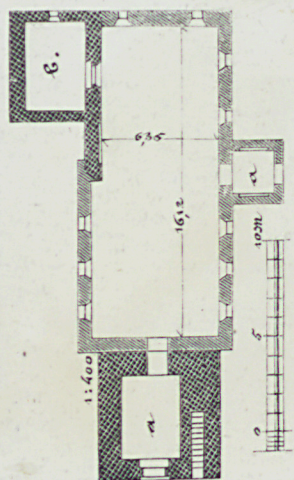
Grembozin, Grundriss der Kirche.
